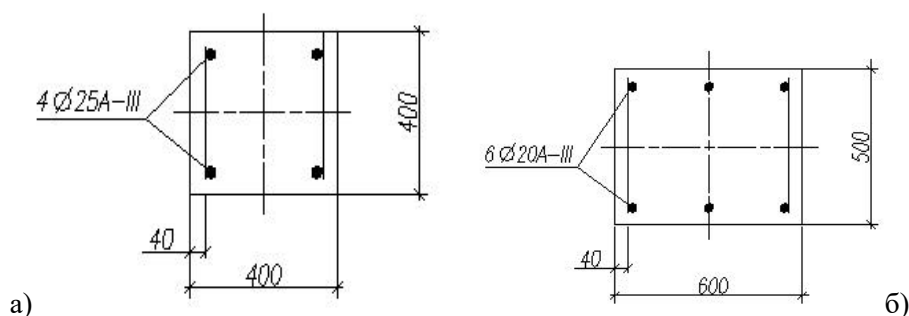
Сечения и армирование крайних (а) и средних (б) колонн каркаса
